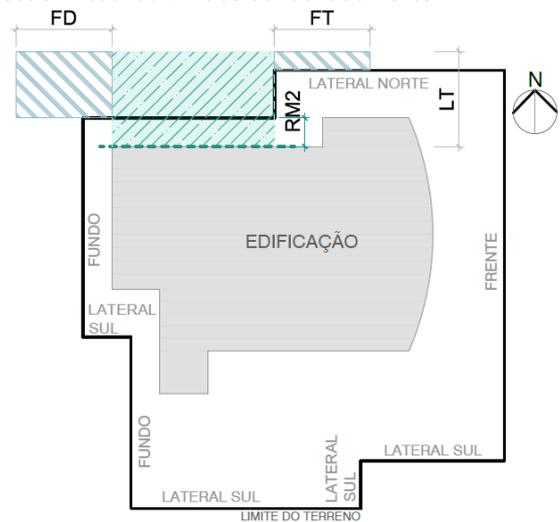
Planta representativa da área de recuo virtual da 2ª face da fachada norte
